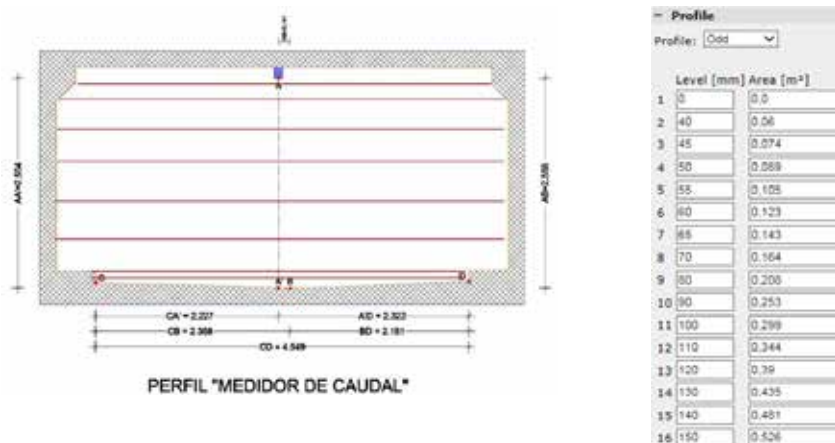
Levantamento topográfico da secção de instalação do medidor de caudal instalado no Caneiro da Falagueira
